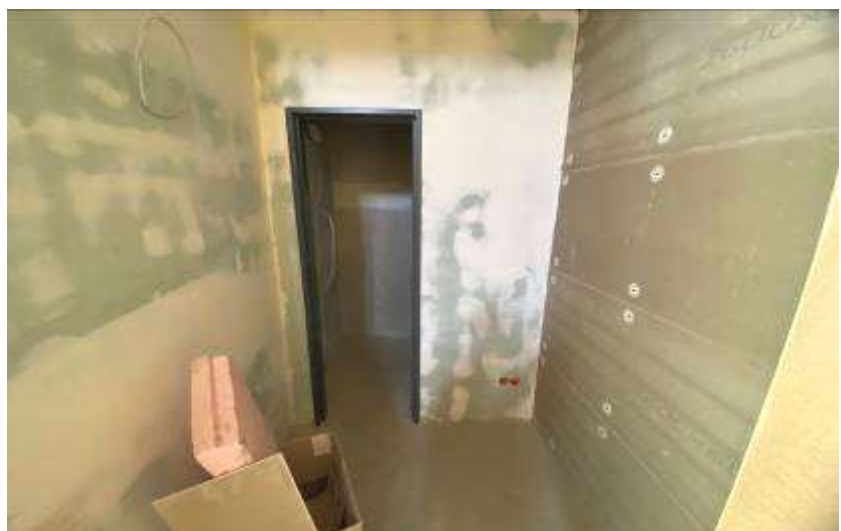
Foto des SV; z.T. unfertige Wandbekleidungen
